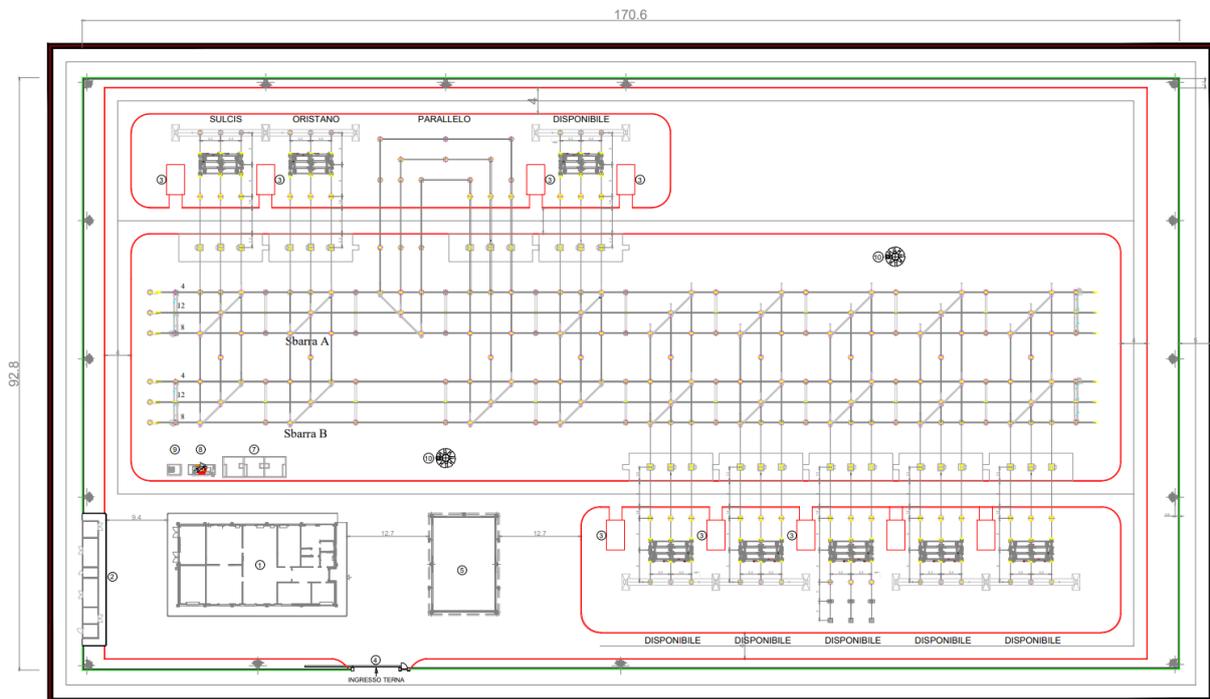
Planimetria futura SE RTN "Gonnesa"
